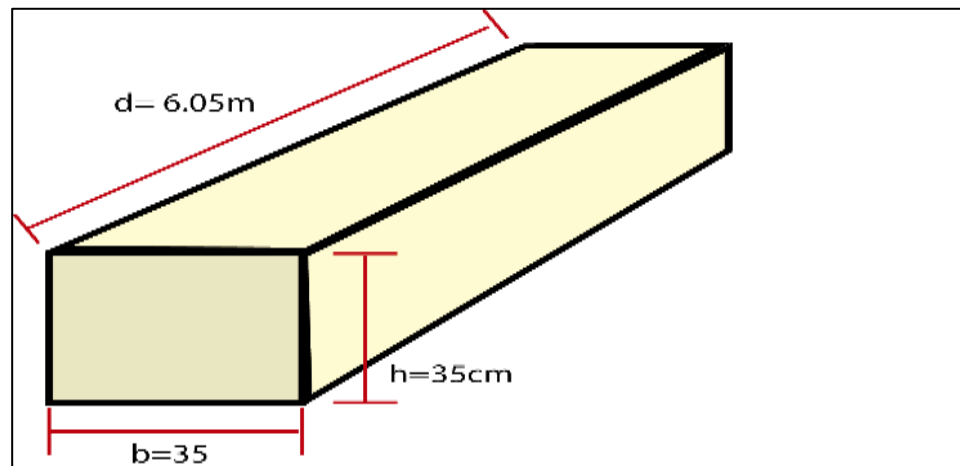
Vista de sección viga; Fuente: [Grupo investigador]
